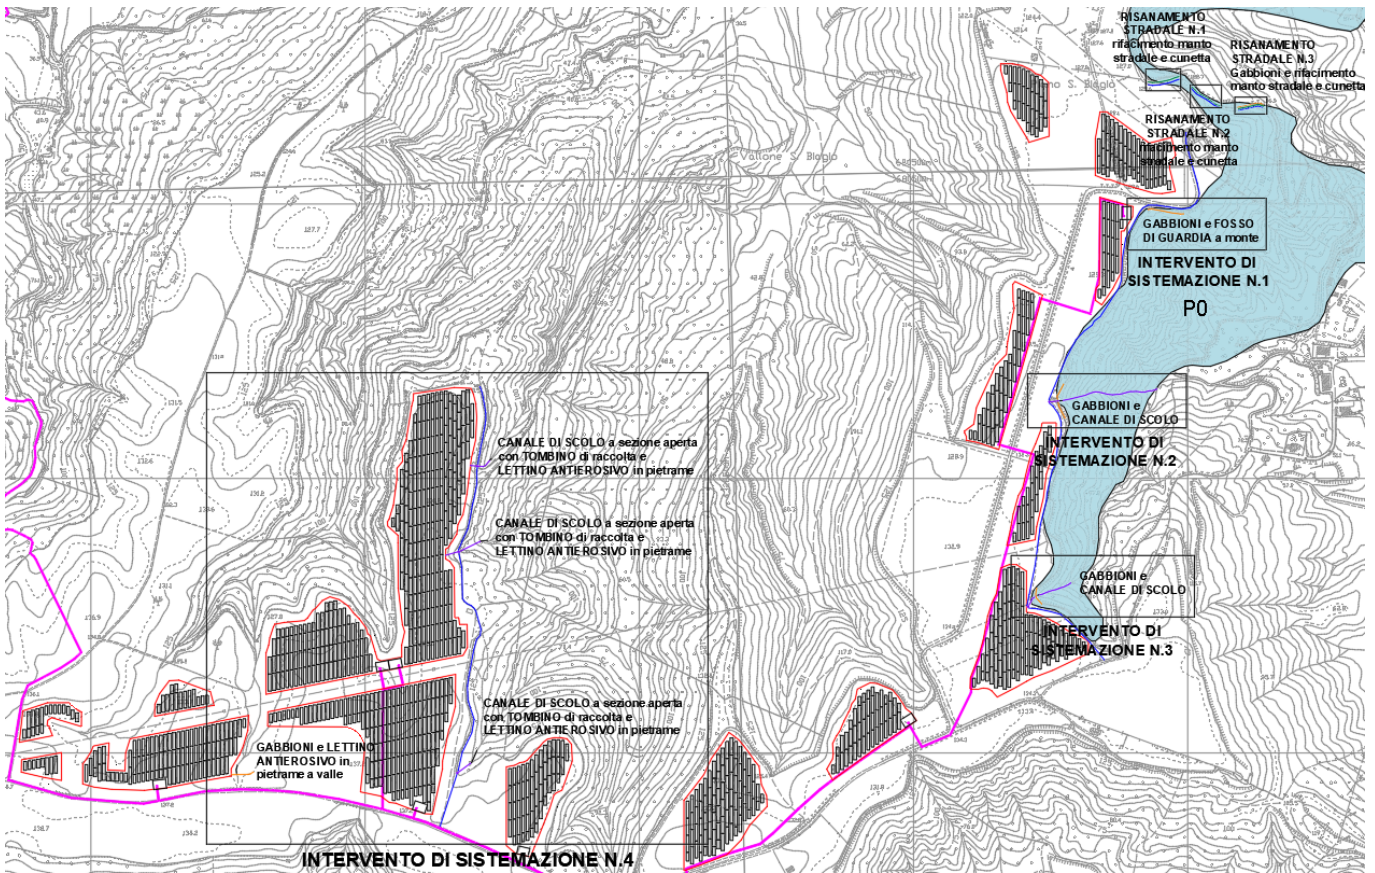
Distanza delle opere di mitigazione dalle aree del Piano Stralcio PAI – Pericolo frana
